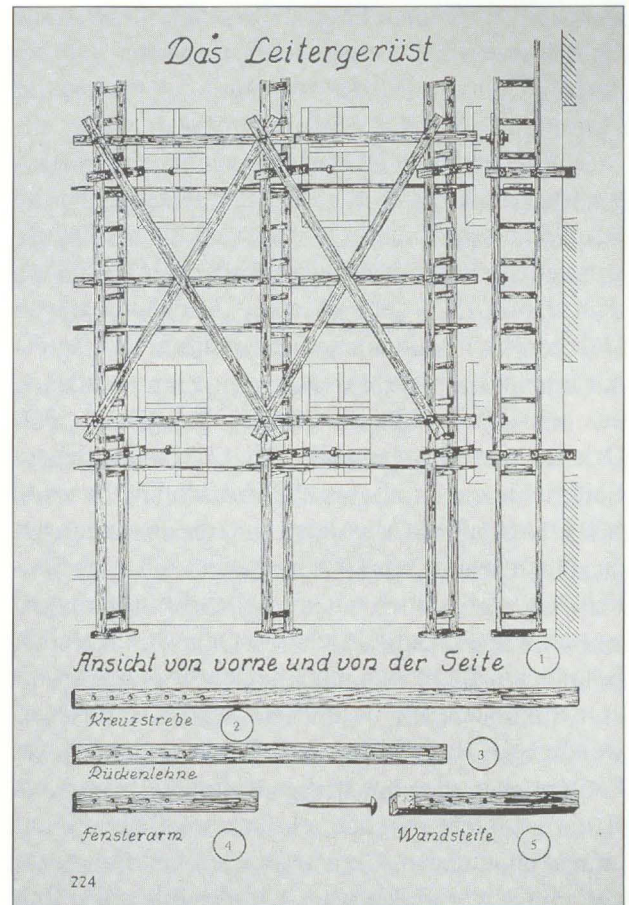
Das Leitergerüst (Dachdecker 1926/1938).
